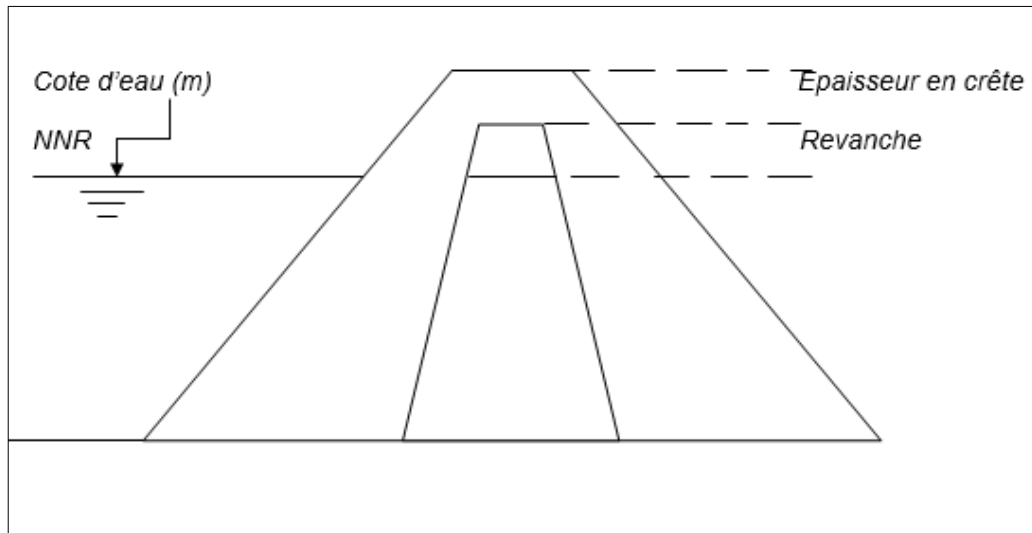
Localisation de la revanche et l'épaisseur en crête d'un barrage en terre
